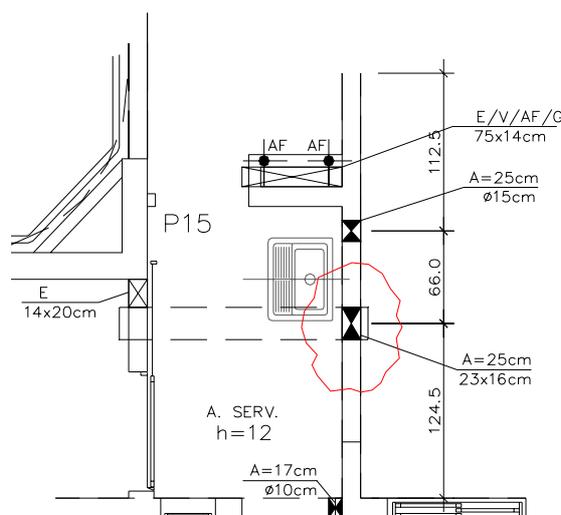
Planta de furação hidráulica do projeto de vedação.
